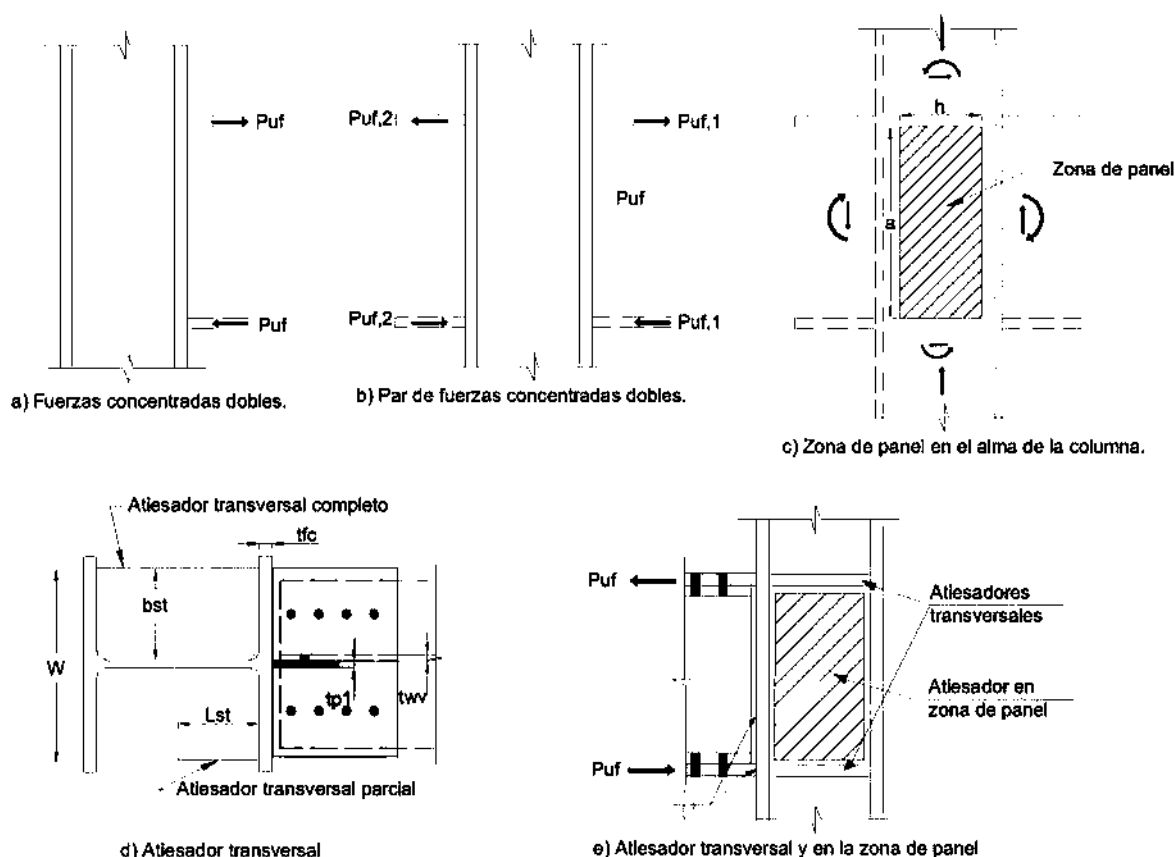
7 Fuerzas y atiesamiento en la columna.
